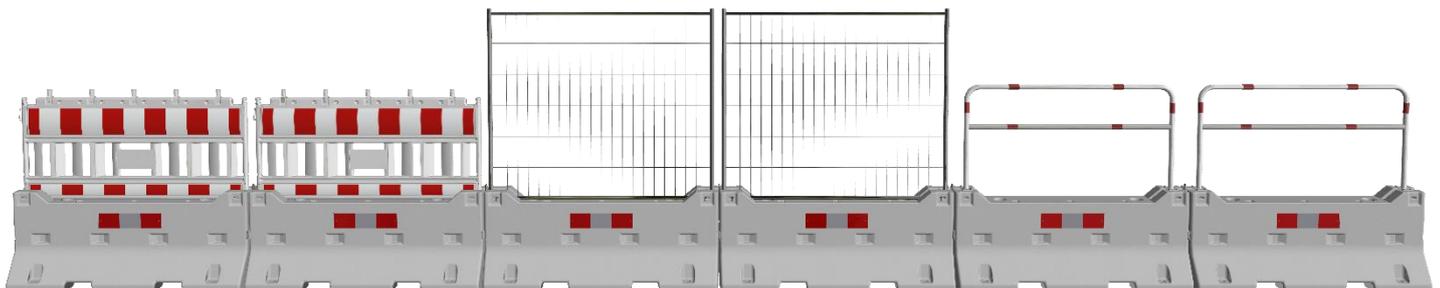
Betonelemente mit Absperrschrankengitter, Bauzaun und Bügel
